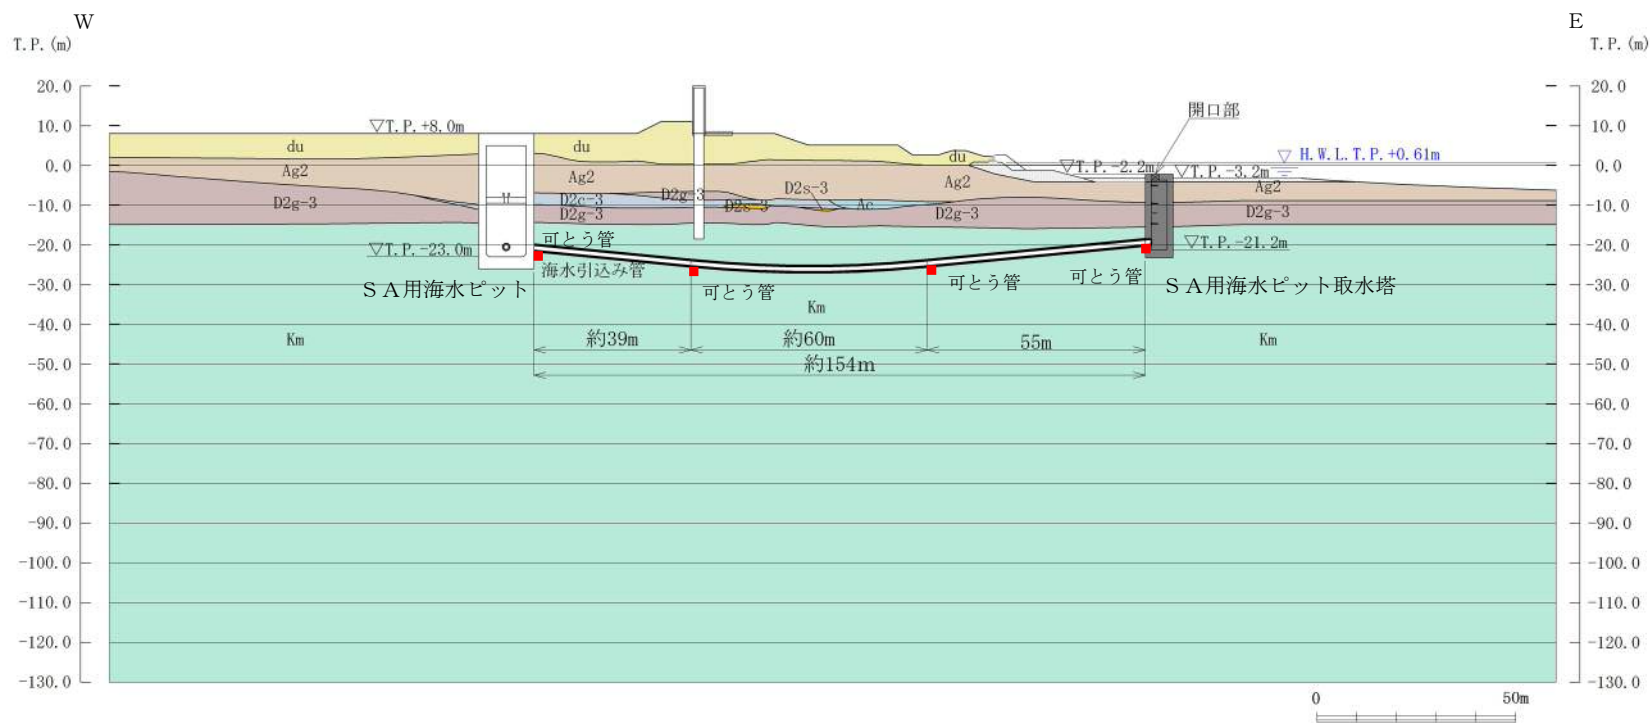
(1) SA用海水ピット取水塔 評価対象断面図 (①-①断面)
